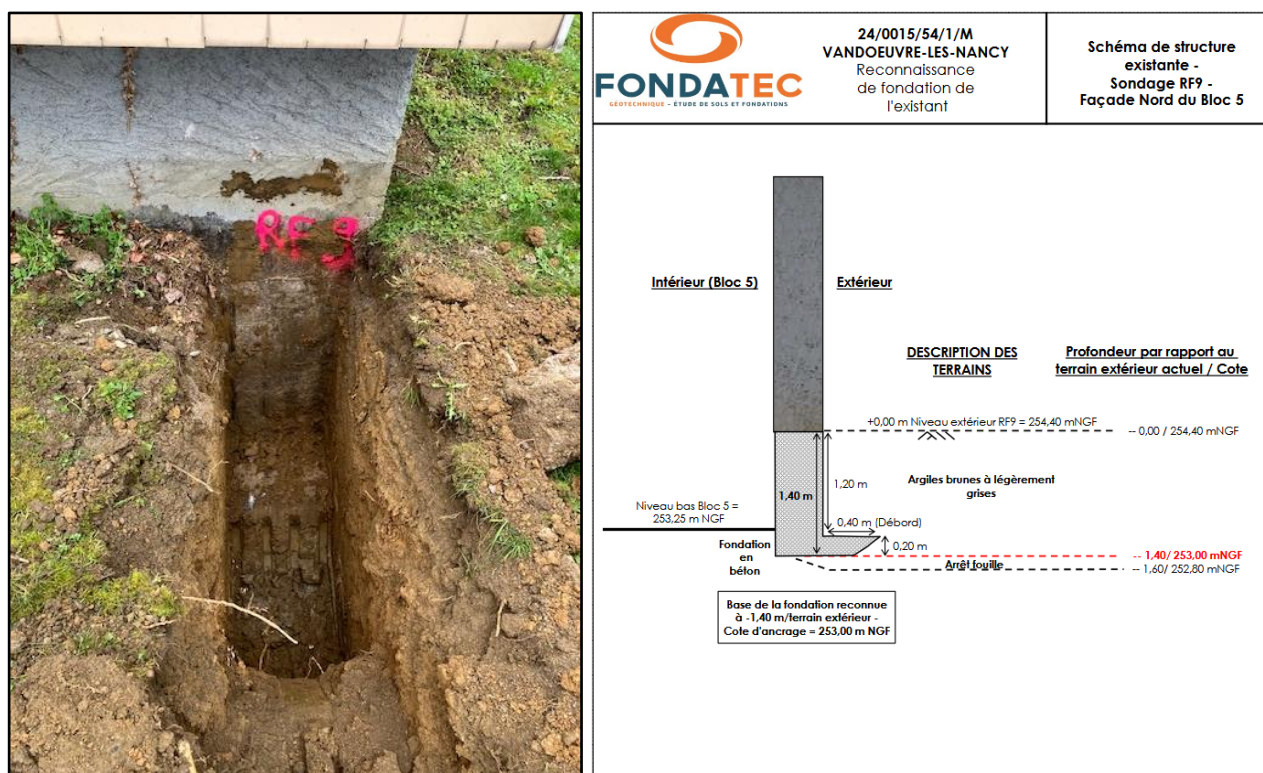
Photographie et coupe de la reconnaissance de fondation RF9 du bloc 5
